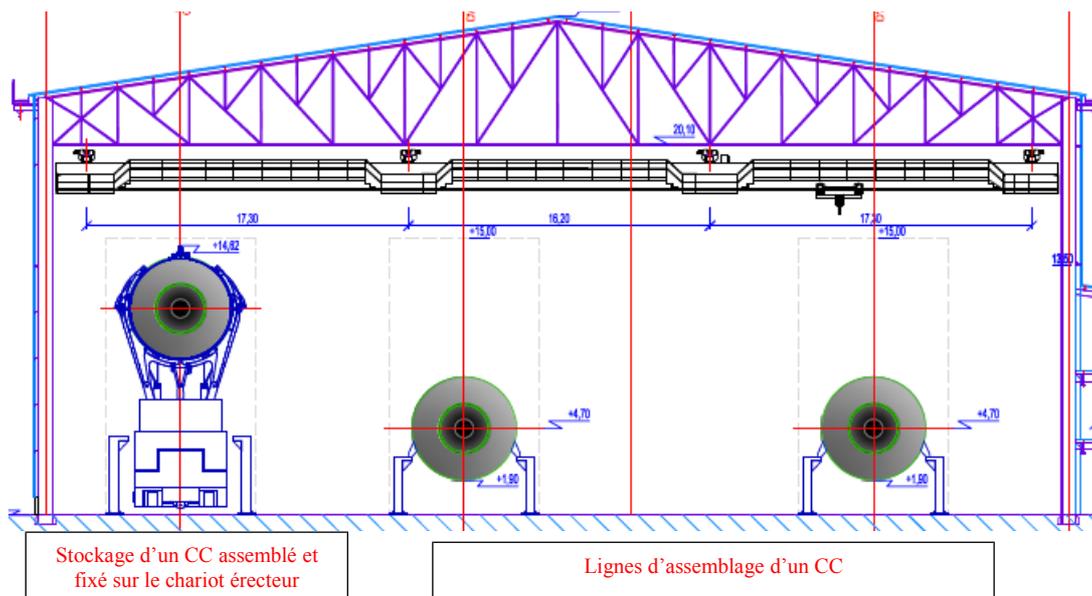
Vue en coupe du hall d'assemblage (plan 3841-XD-1739-0310-A)
